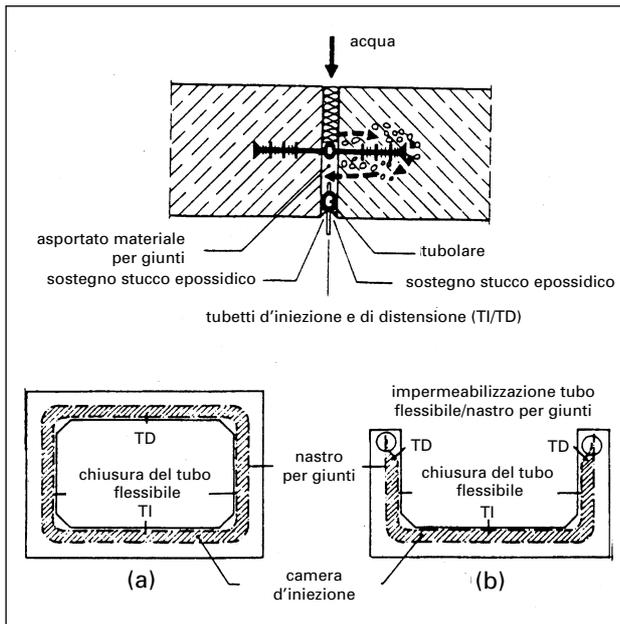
Impermeabilizzazione successiva con iniezione di un giunto di dilatazione con un nastro interno [4.49].
